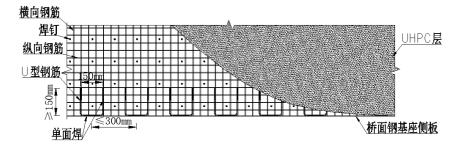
UHPC 层与钢结构连接示意图(U型钢筋连接)
